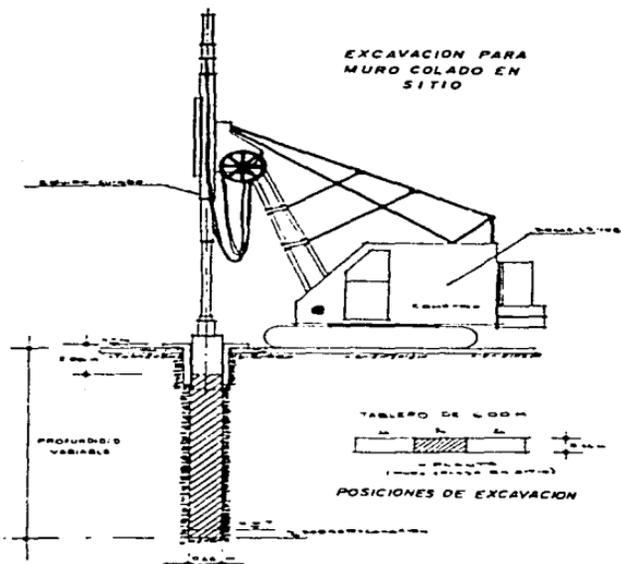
EXCAVACION PARA UN MURO TABLESTACA
